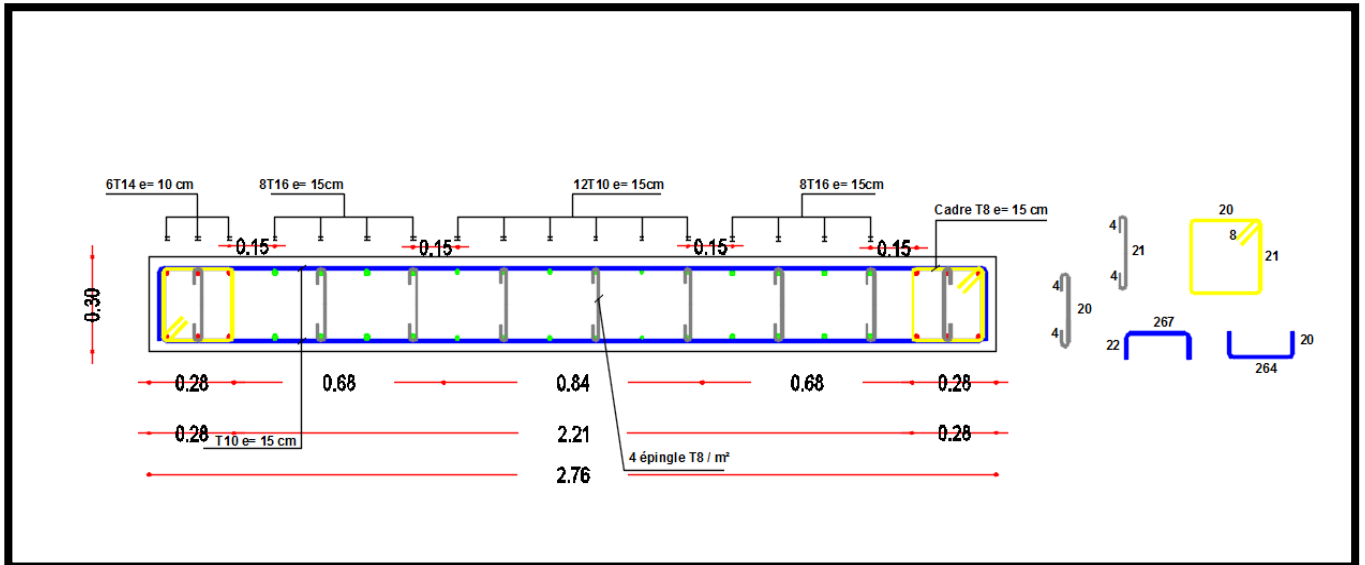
Coupe horizontale de ferrailage du trumeau
